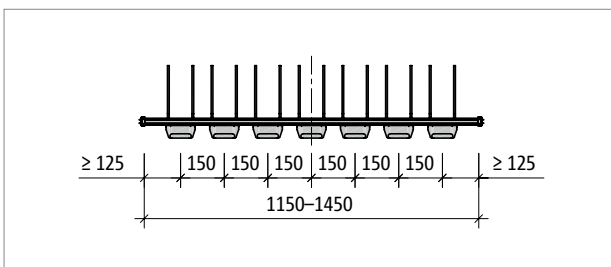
Schöck Tronsole® typ T-V6...-L1000 až L1300: Půdorys prvku
